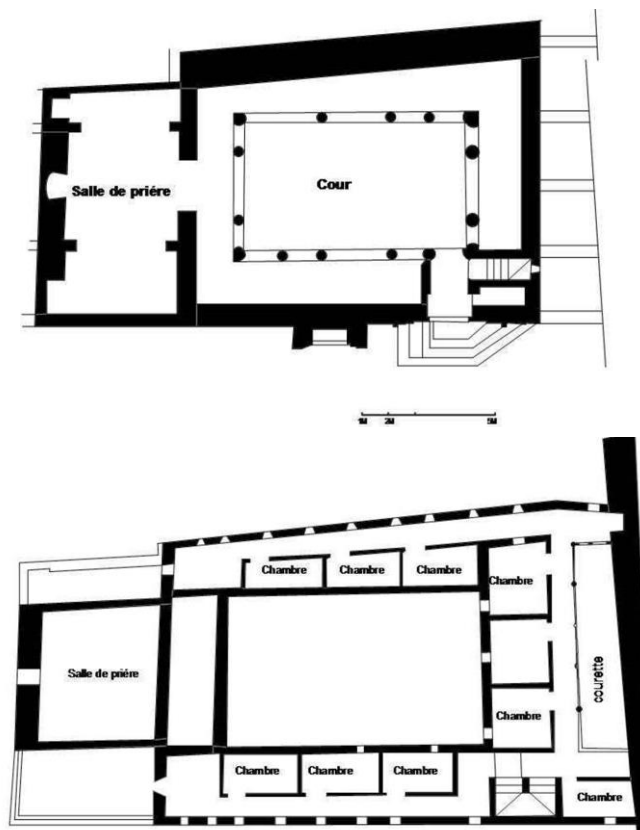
Vues en plan de la medersa de la medersa d'Abù el-Hassane à Salé, le rez-de-chaussée en haut et le premier étage en bas.
